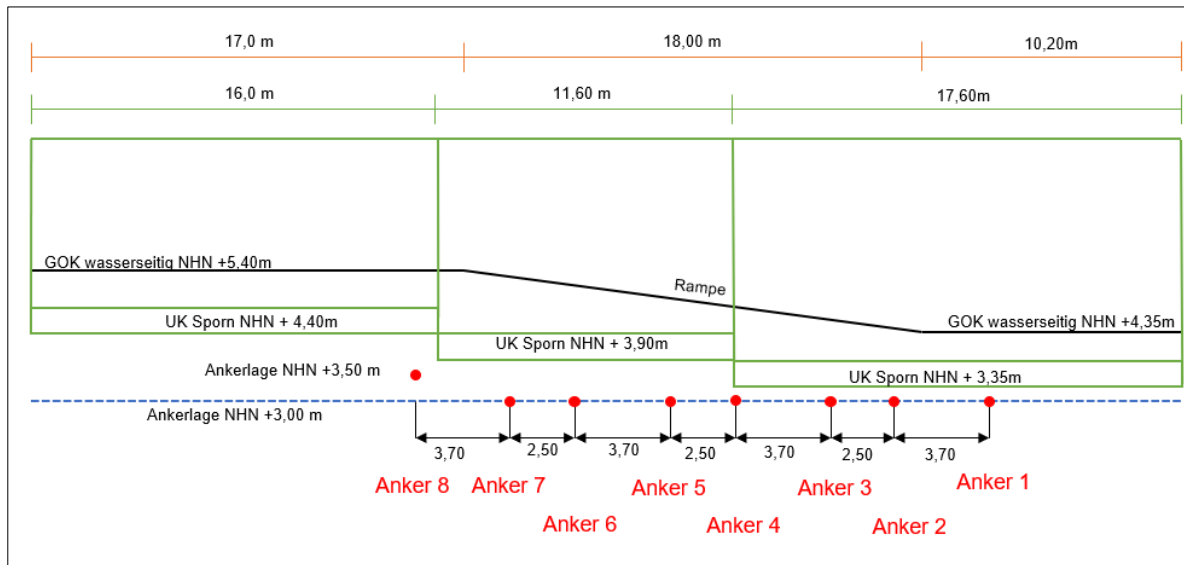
Teilabschnitt I; Längsschnittskizze im Bereich der Rampe mit Darstellung der Ankerlage
